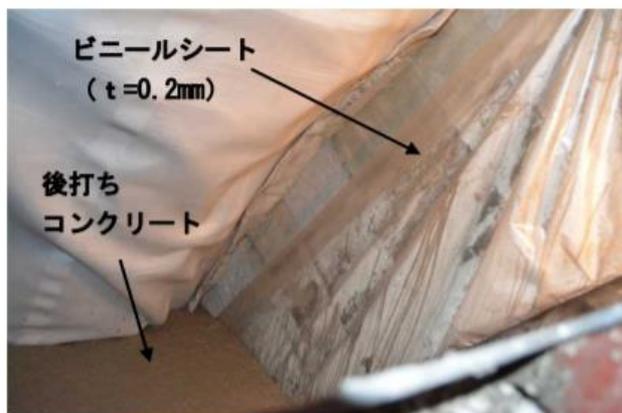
施工目地へのピニールシート設置状況 (コンクリート打設中)
